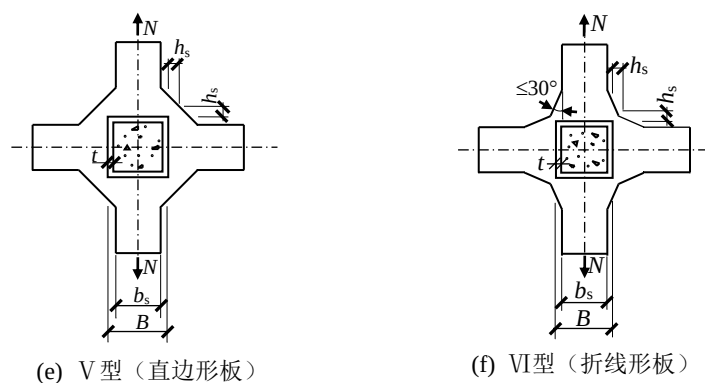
矩形钢管再生混凝土加强环板的类型示意图
